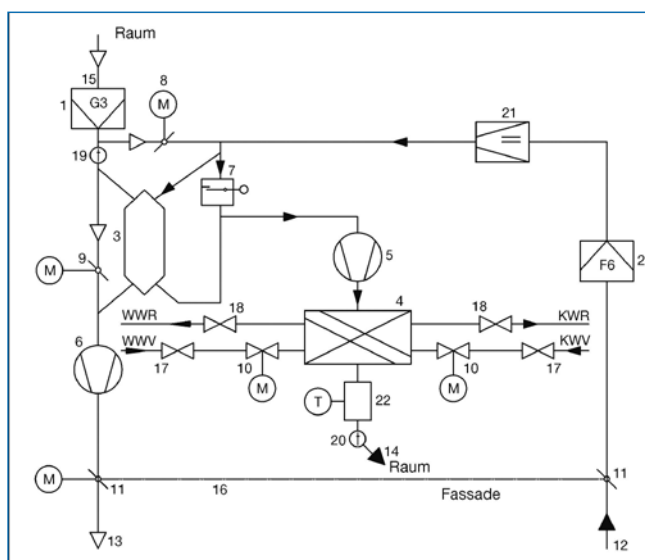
Funktionsschema Fassadenbrüstungsgerät FSL (Trox GmbH, Neukirchen-Vluyn)
